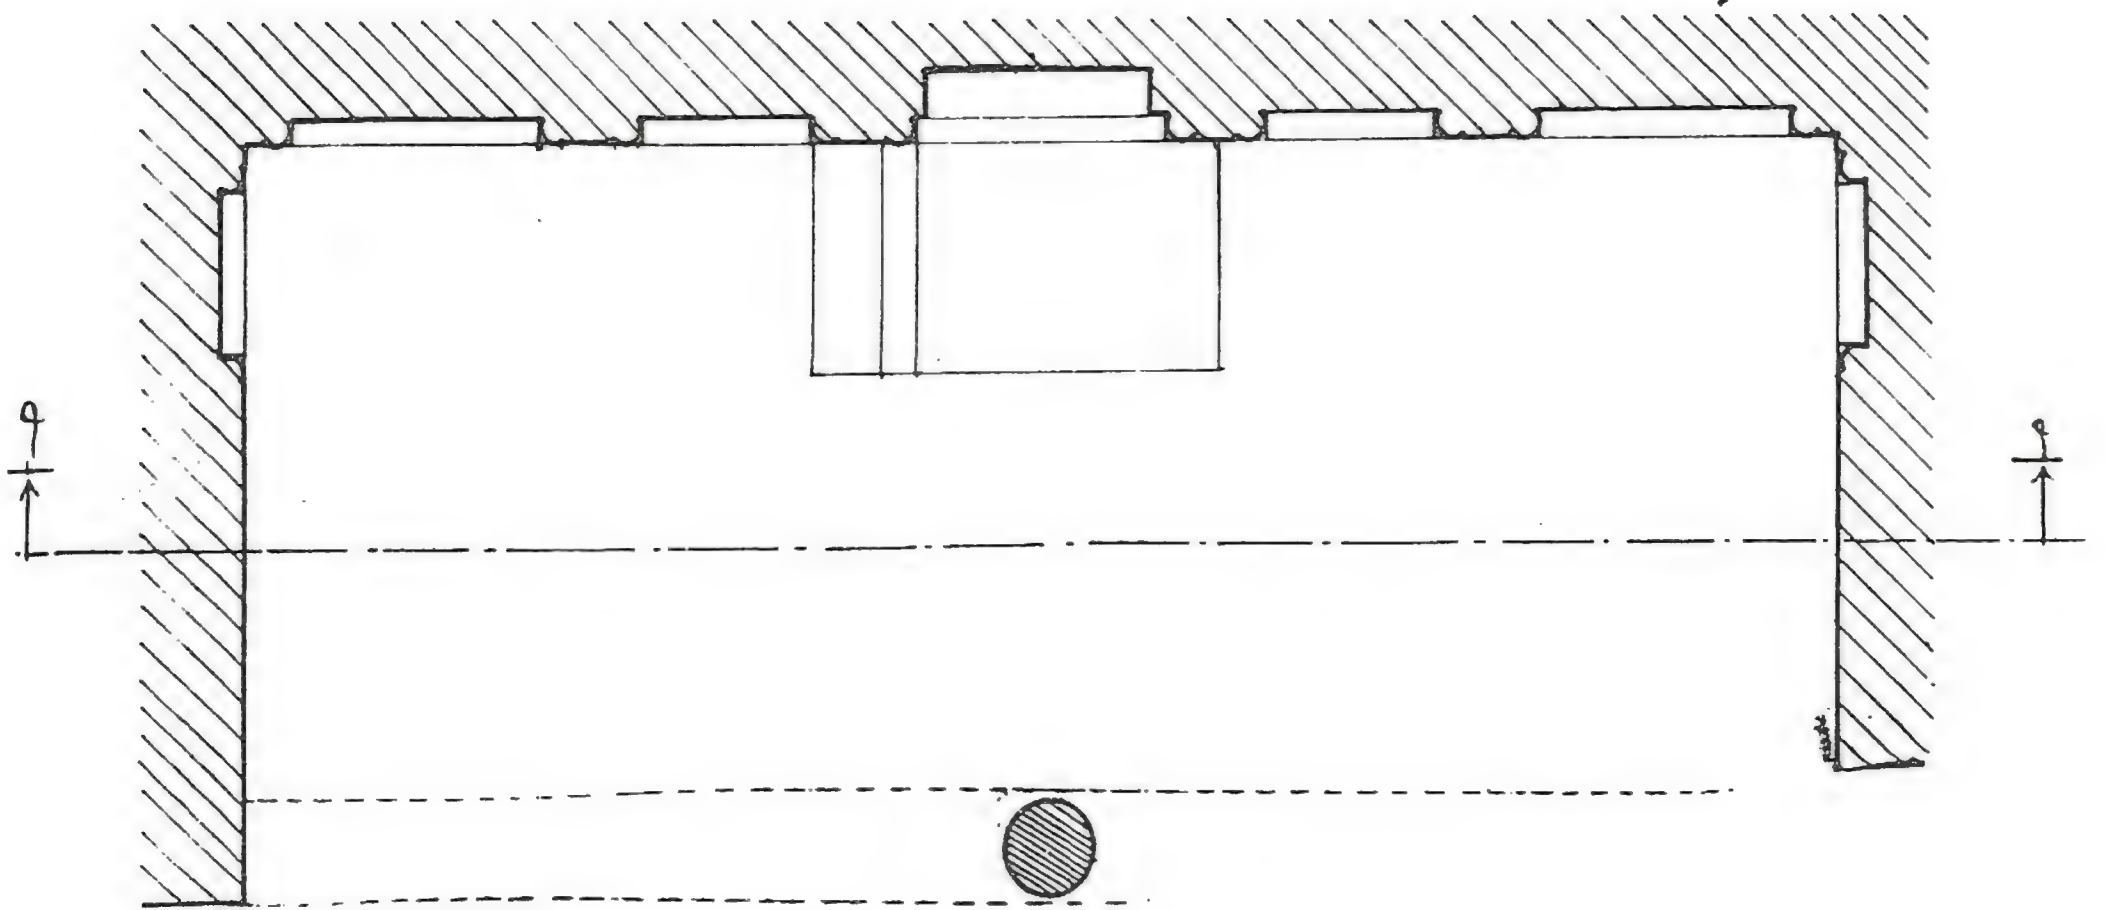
مسقط أفقى لحوض إبراهيم أغا
